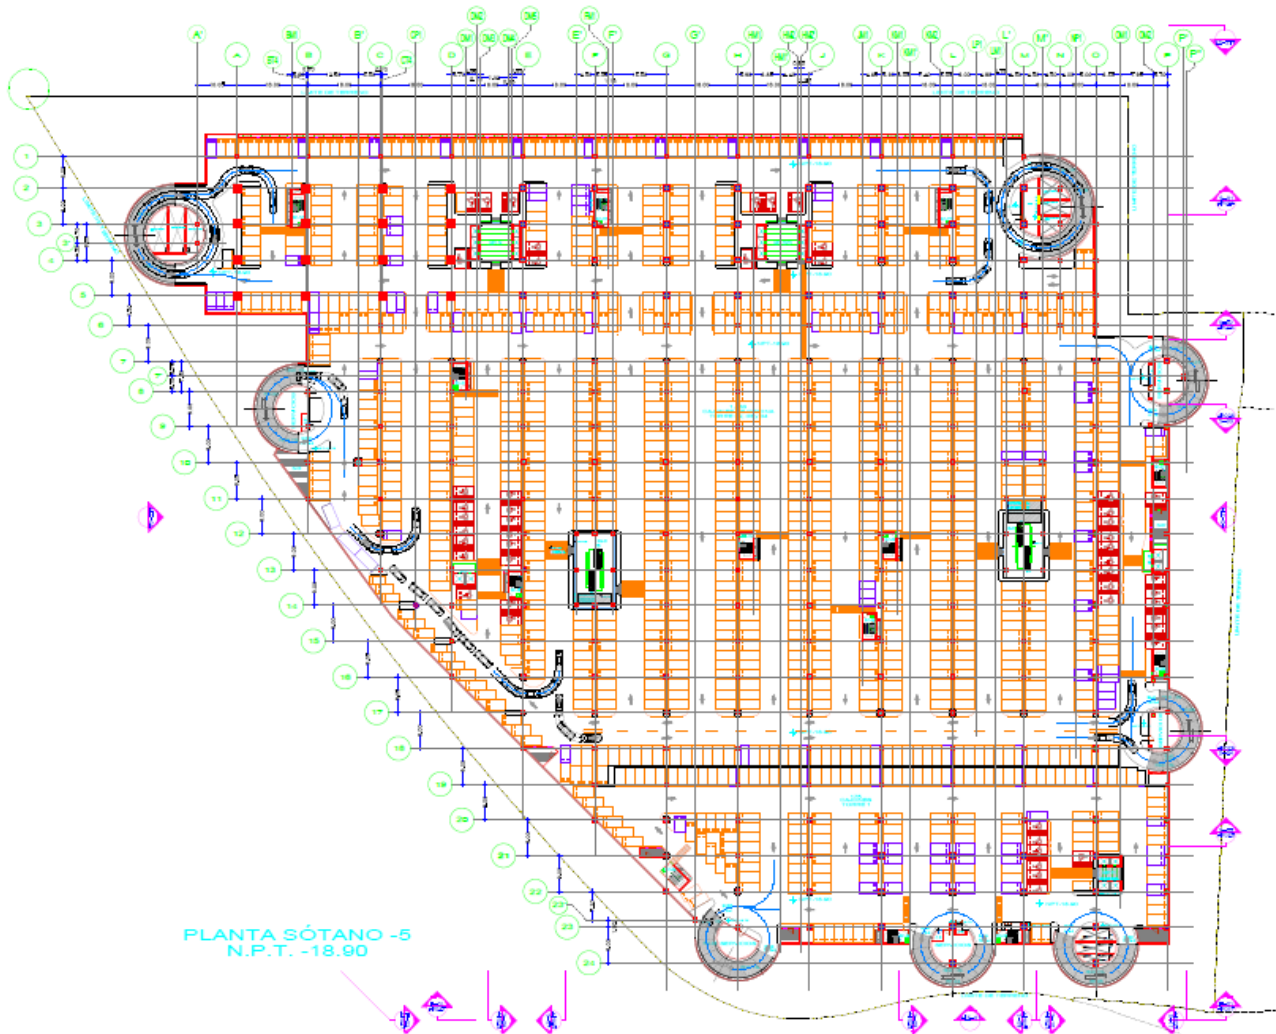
Planta tipo de Sótano 1 a Sótano 5.
